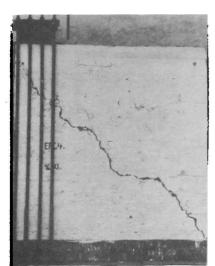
Muro Ch 3s, ladrillo conchón, compresión diagonal.
